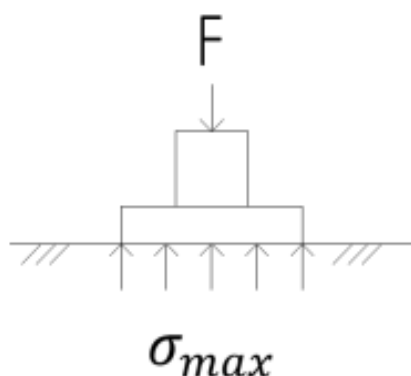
Расчетная схема столбчатого фундамента
